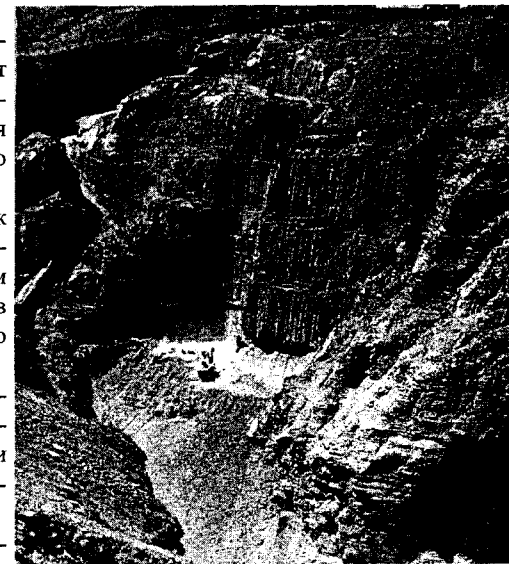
Потенциально-неустойчивый блок на левом борту котлована гидроэлектростанции после вывала опоры в его основании
